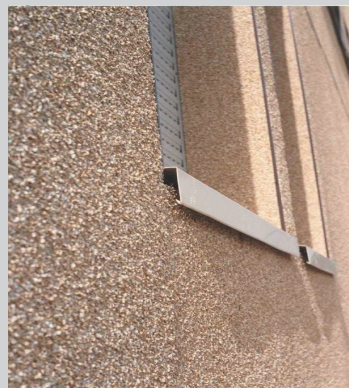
B – Pormenor de uma janela da fachada da solução anterior
